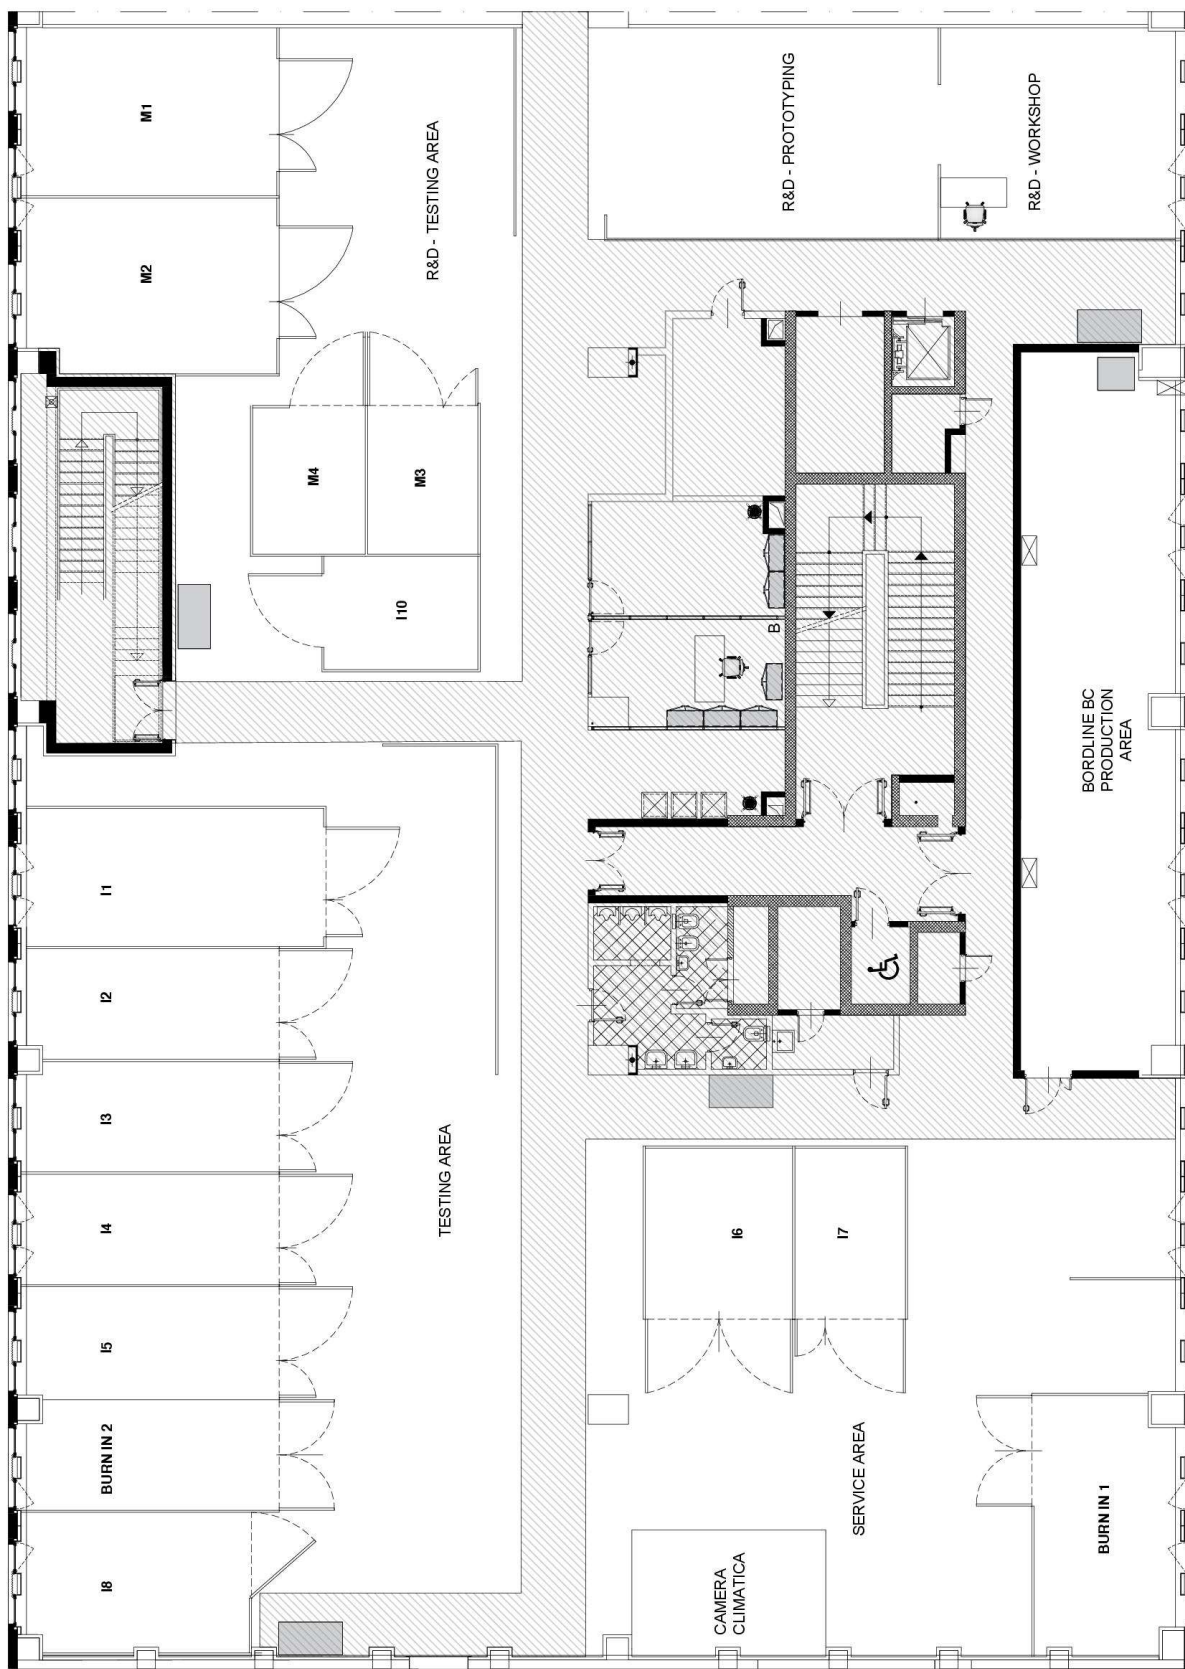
Attuale planimetria dell'area occupata al primo piano dalla divisione MOTR nello stabilimento
